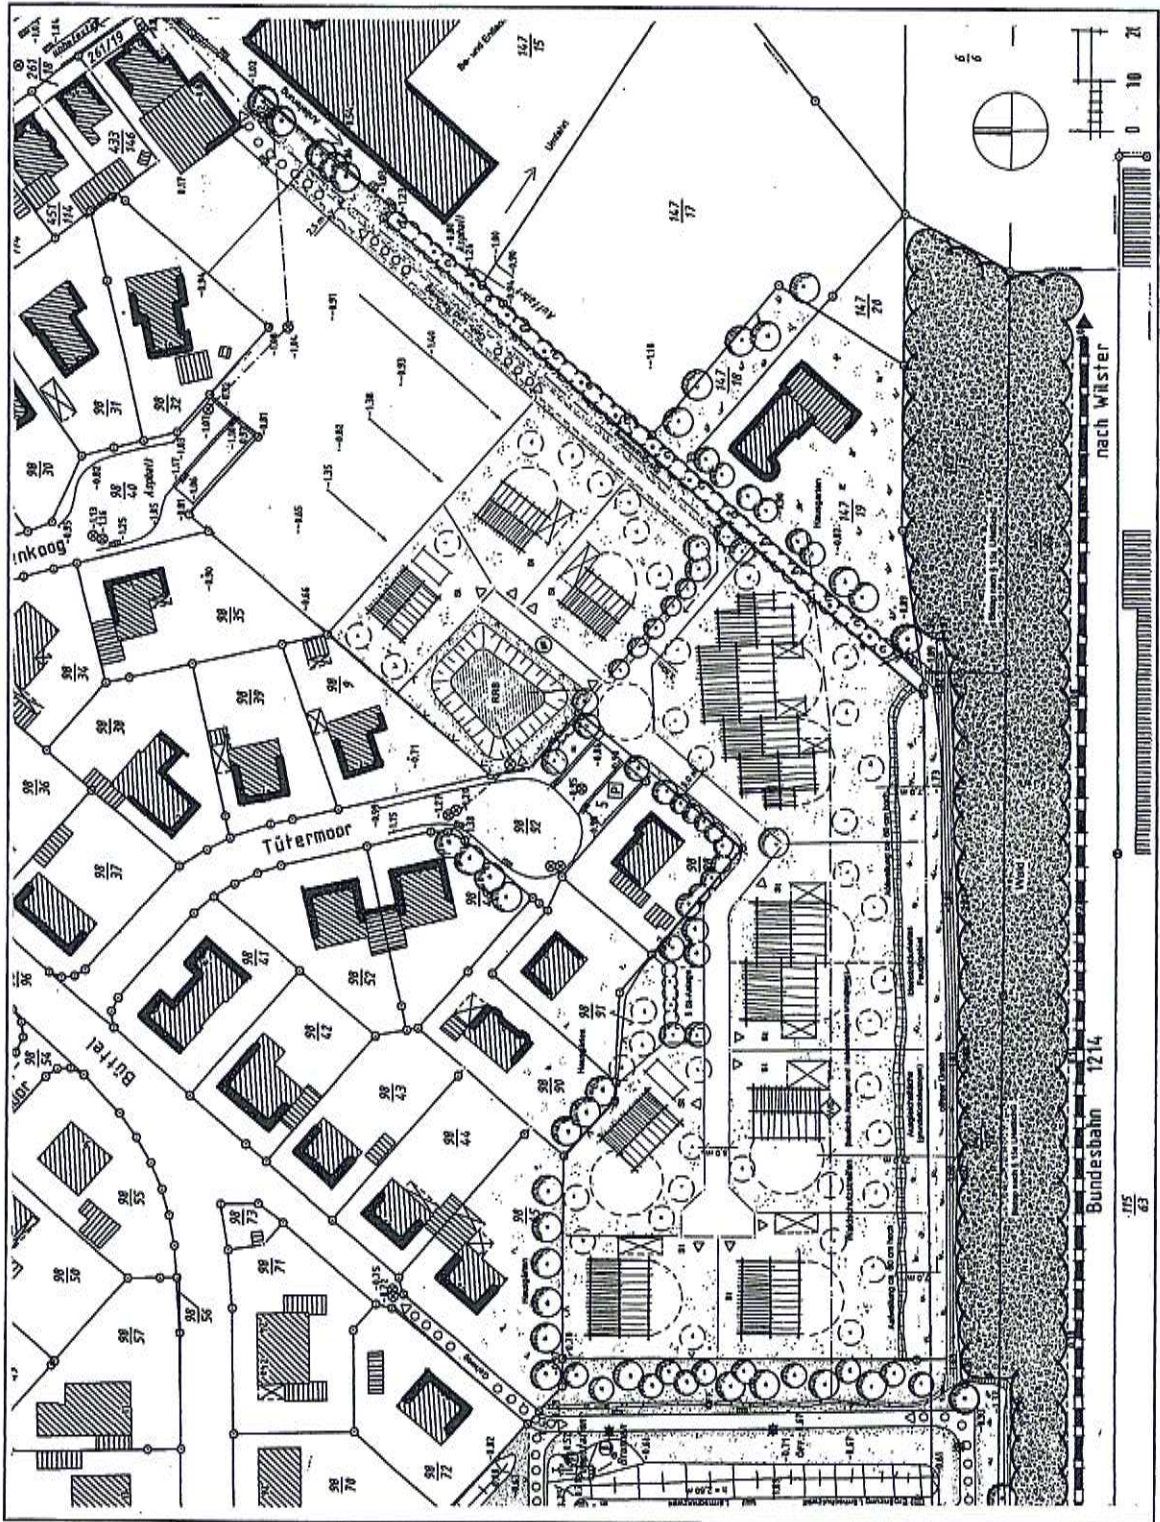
Städtebauliches Konzept (mit integrierter Landschaftsplanung und tiefbautechnischen Begleitung) - Entwurf - vom 11.04.1999, unmaßstäblich
